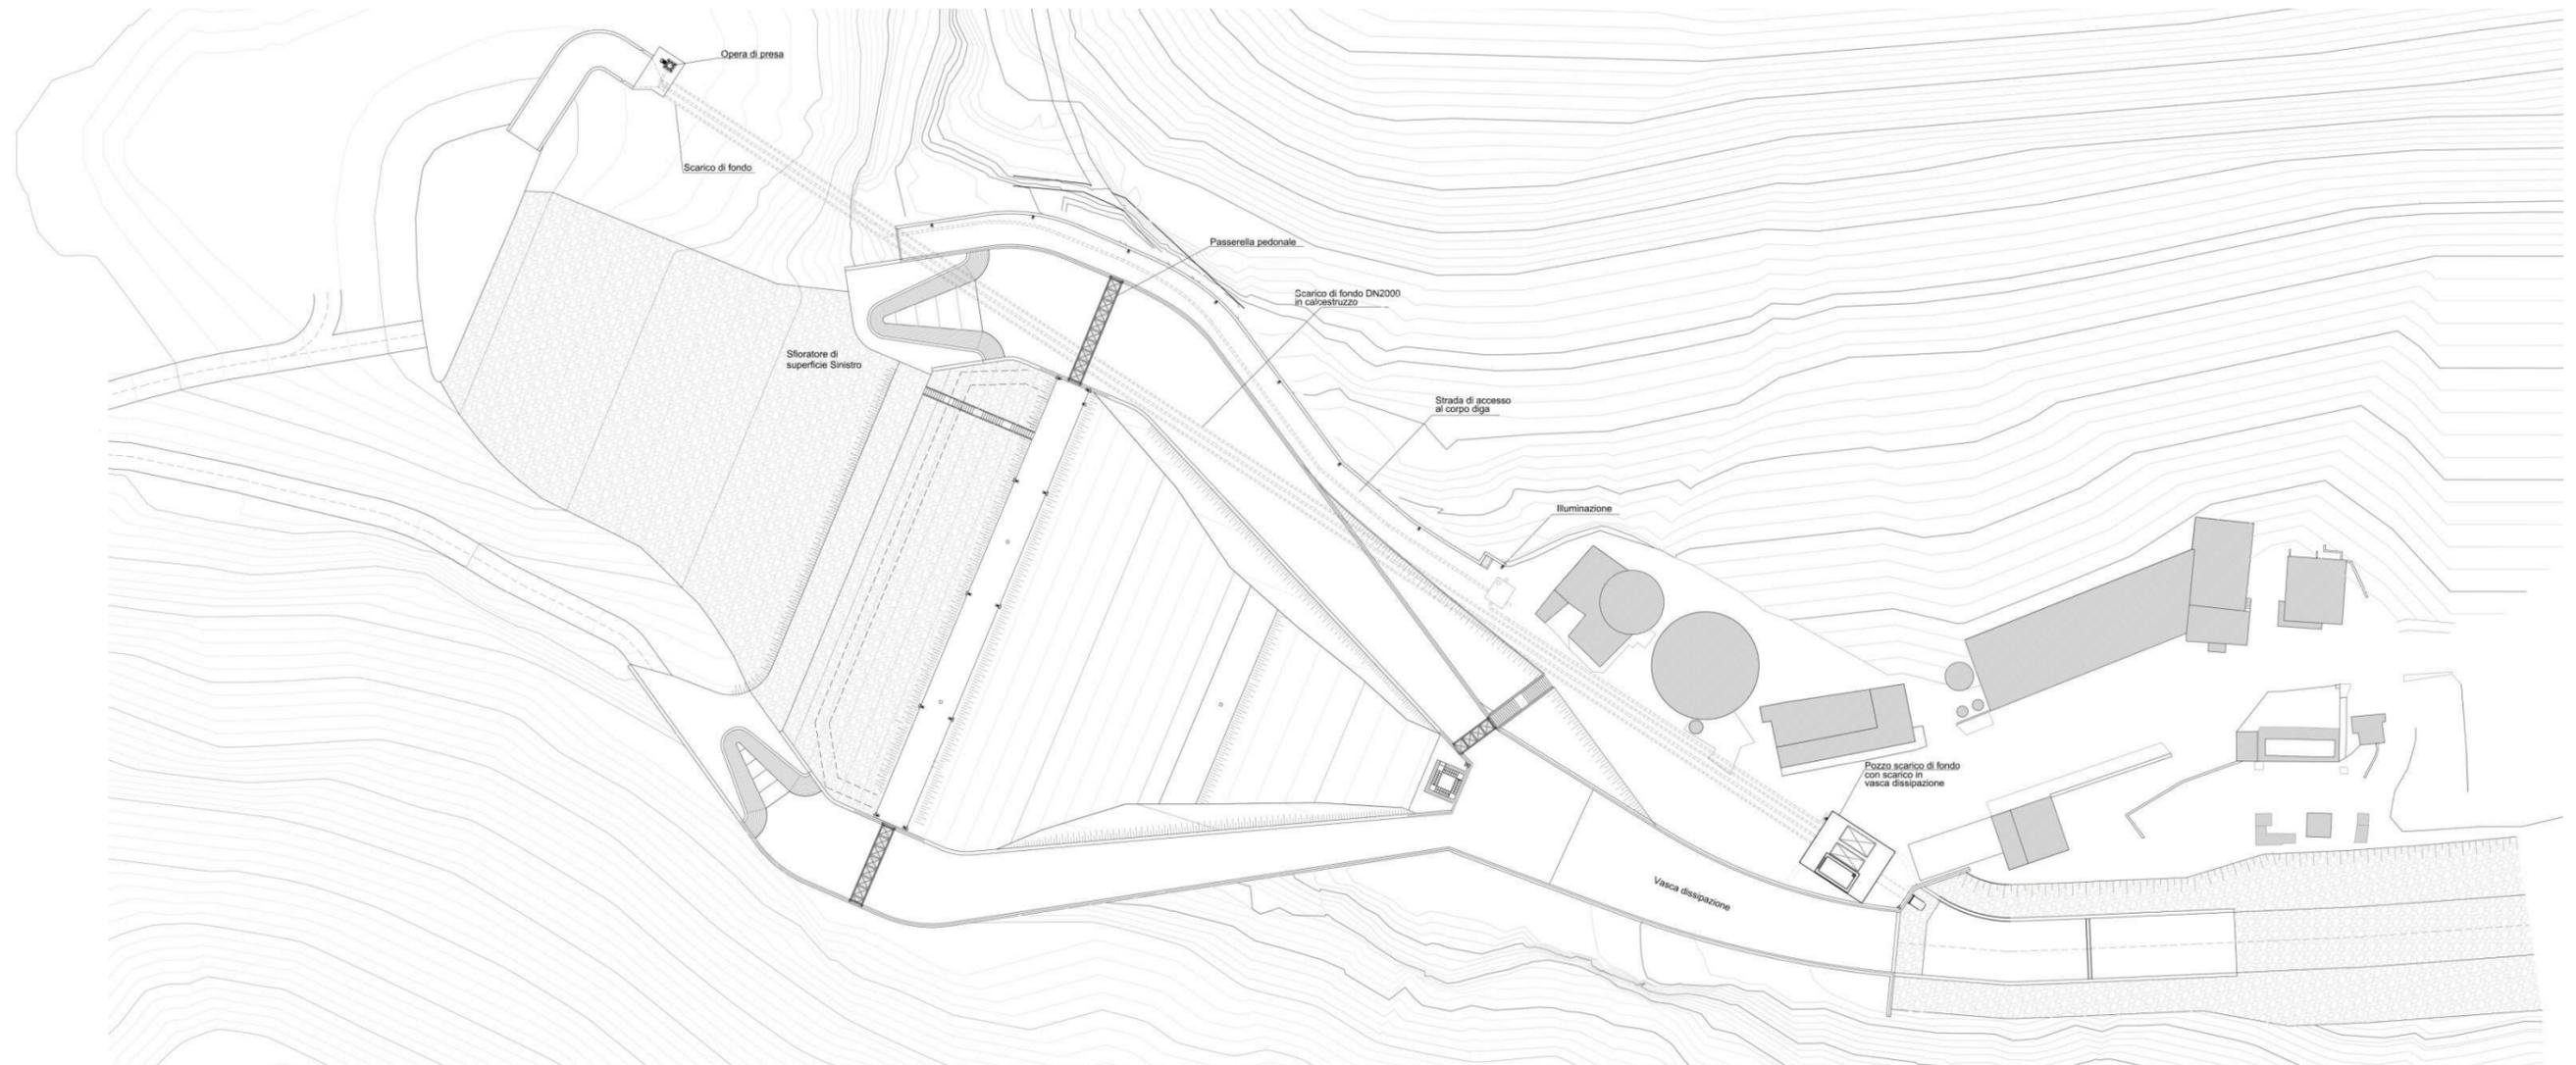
Planimetria della diga Drove di Cepparello stato di progetto
